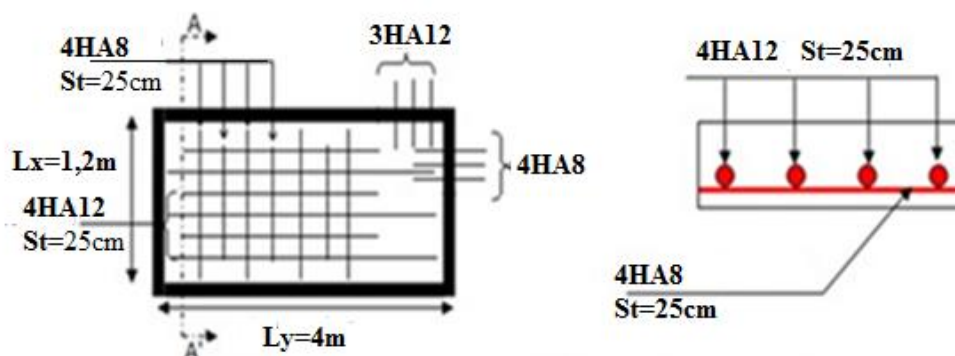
Schéma de ferrailage de la dalle sur 4 appuis.
